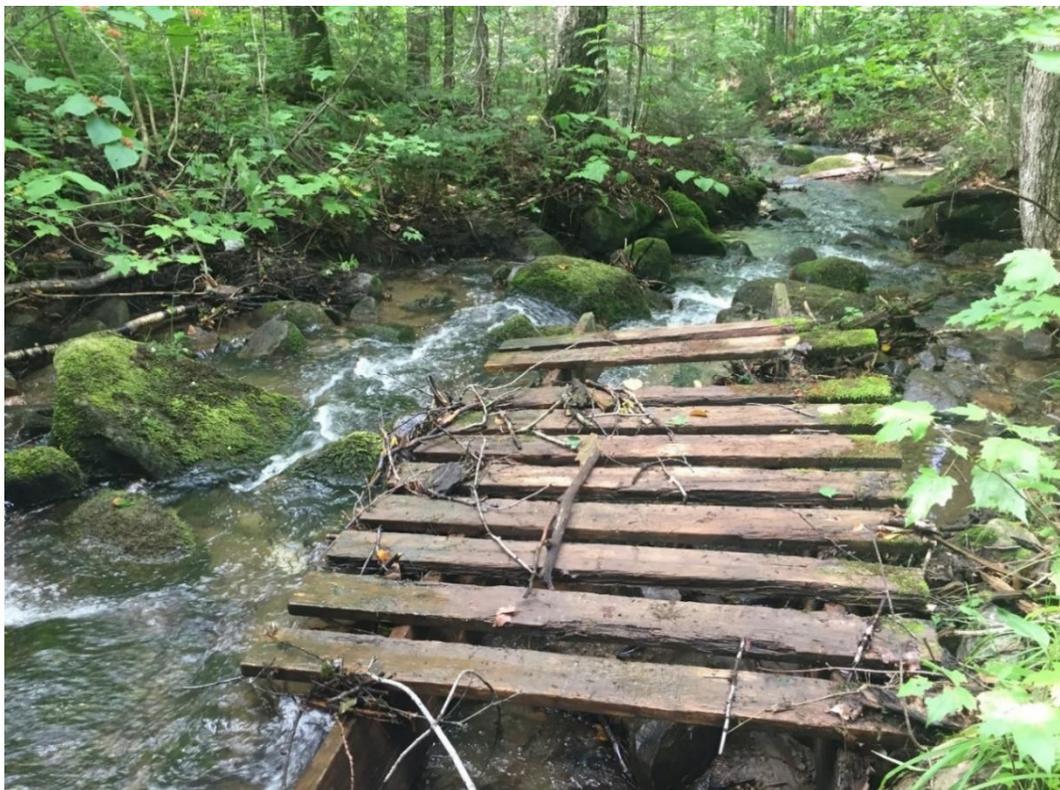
Débris de construction en bois dans le ruisseau du Mont Hibou (section 4)
